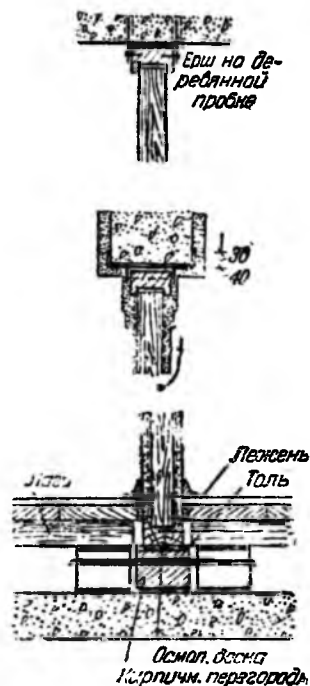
Установка деревянной перегородки на железобетонном перекрытии
